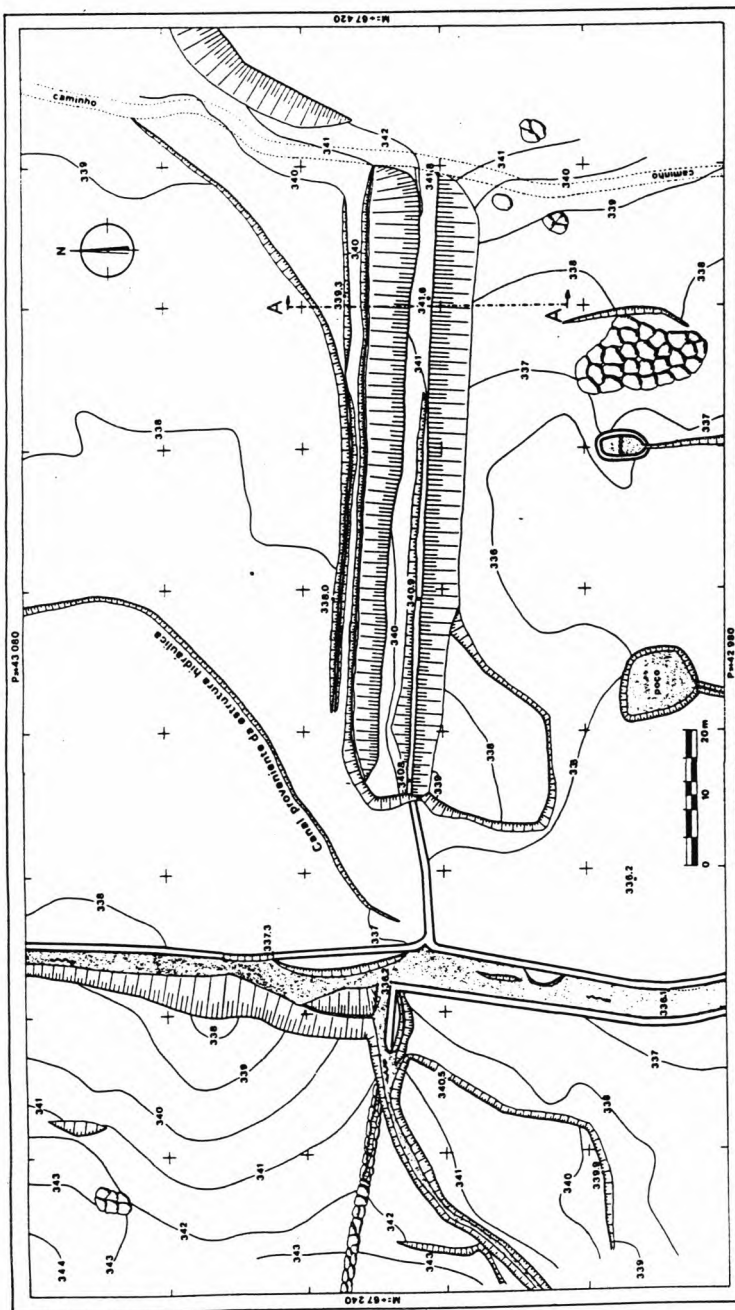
Barragem da Orca (Fundão). Planta da barragem
